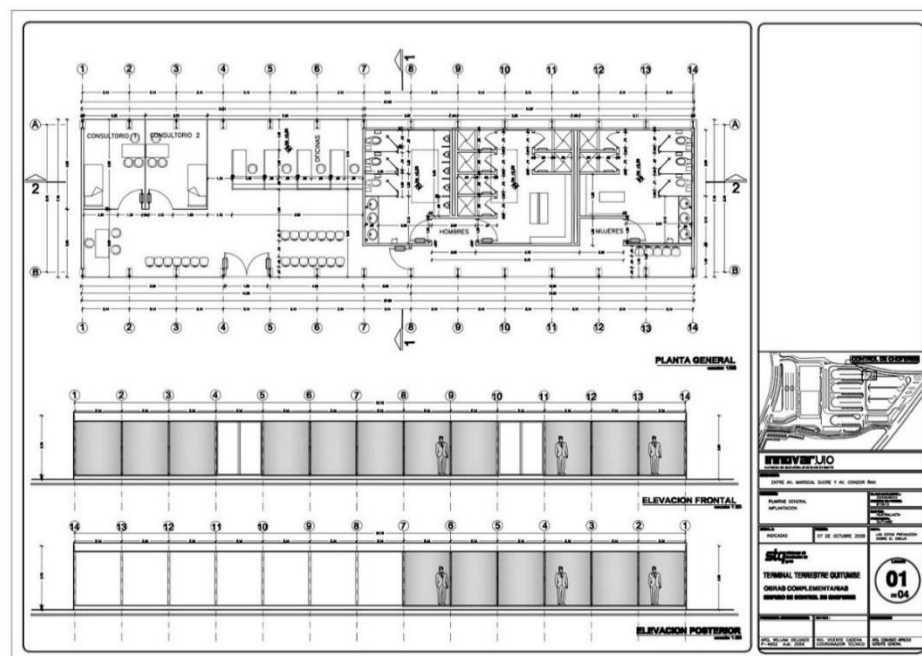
Planta del edificio operativo*Figura 51. *Planta y fachada del edificio de choferes
